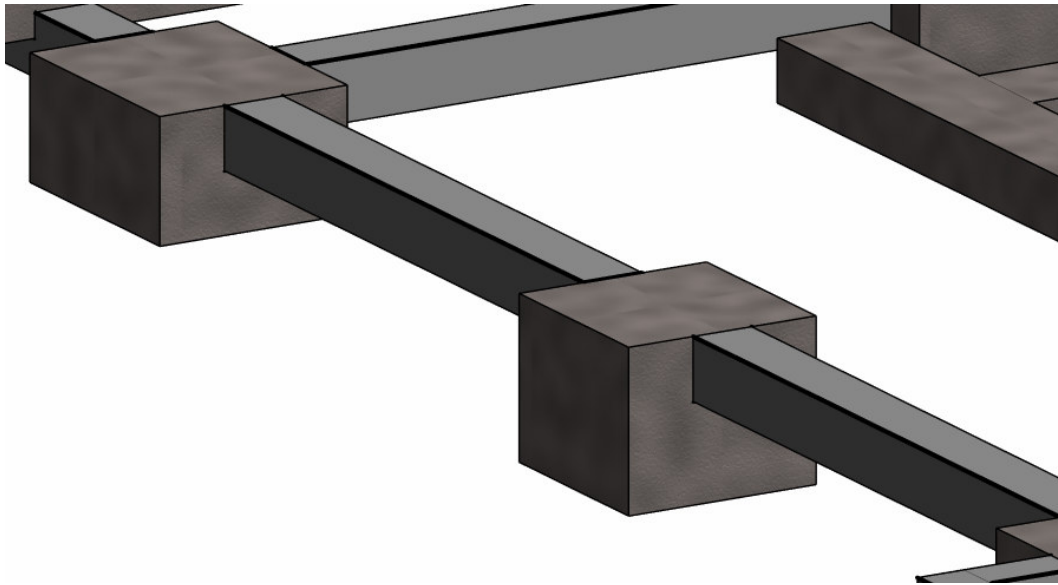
Zapatas aisladas unidas mediante viga de atado.
